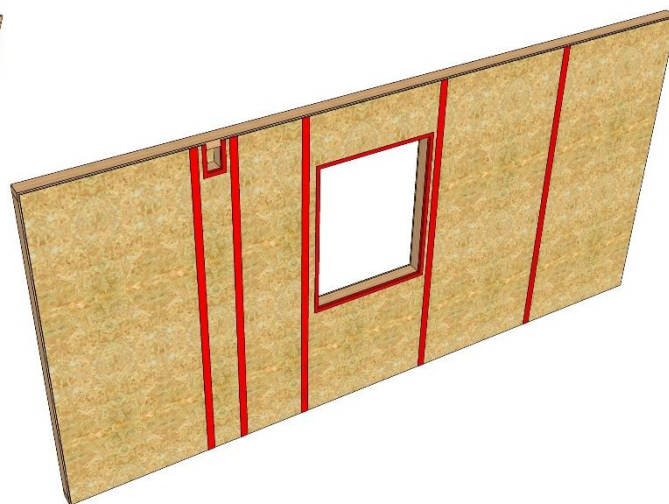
Traitement de l'étanchéité au droit des jonctions des plaques de parement intérieur
